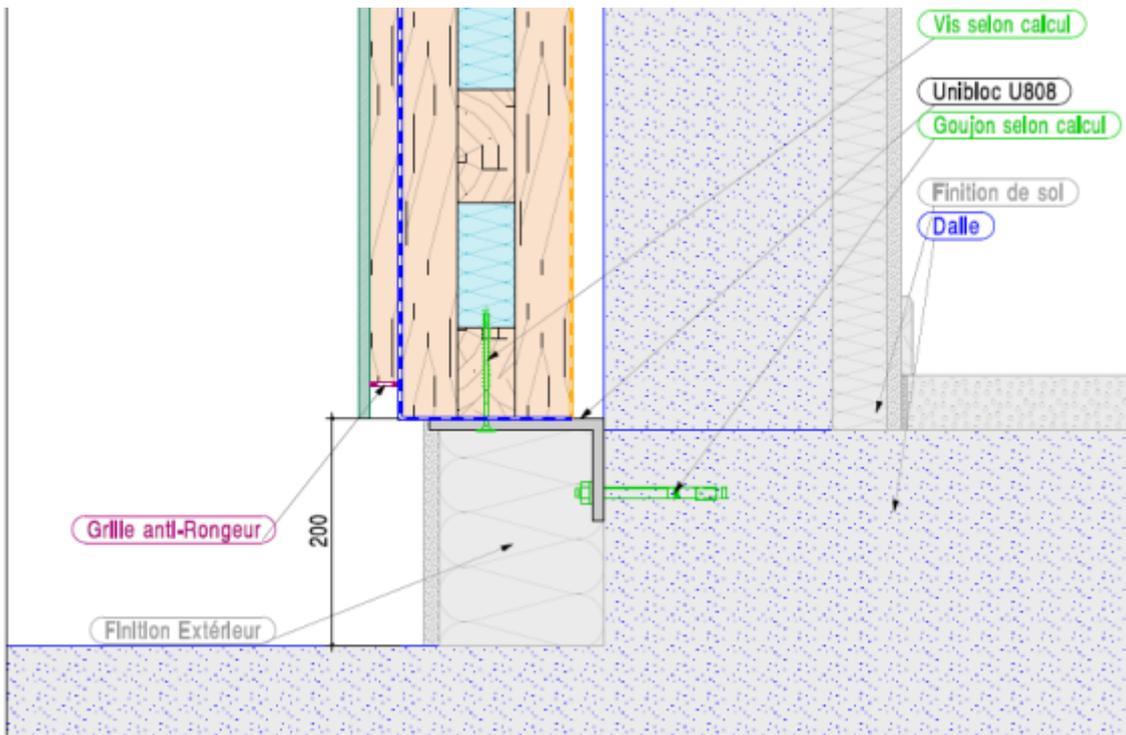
Jonction en nez de dalle sur béton en pied de façade en mur manteau / Coupe verticale
